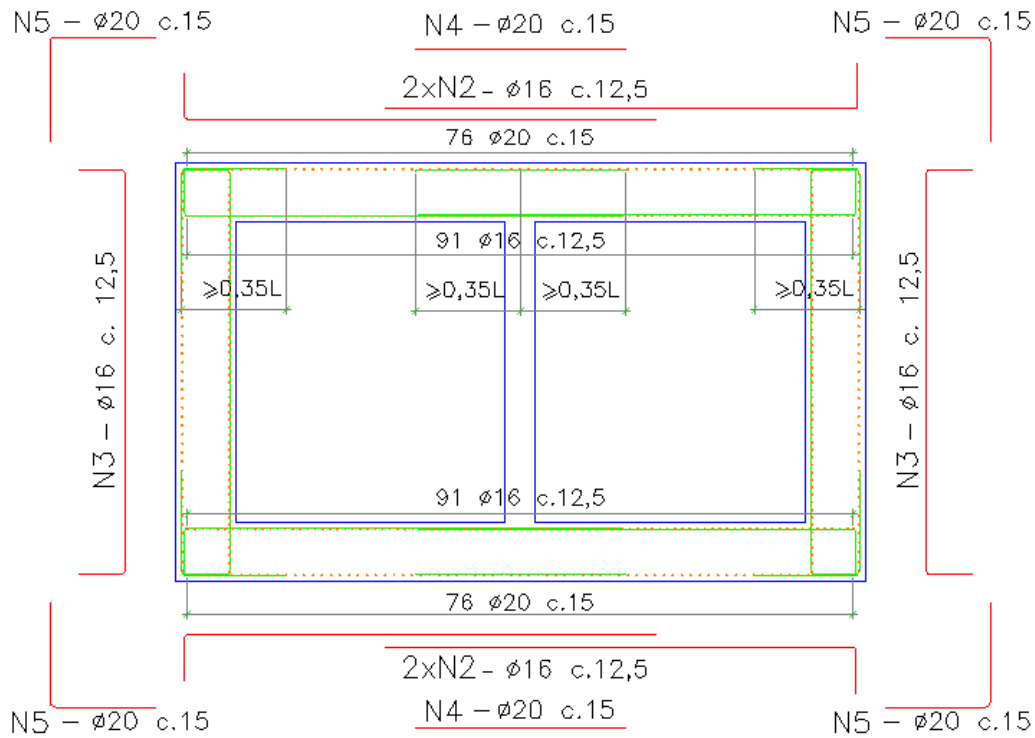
Esquema das armaduras nas seções com pilar central
